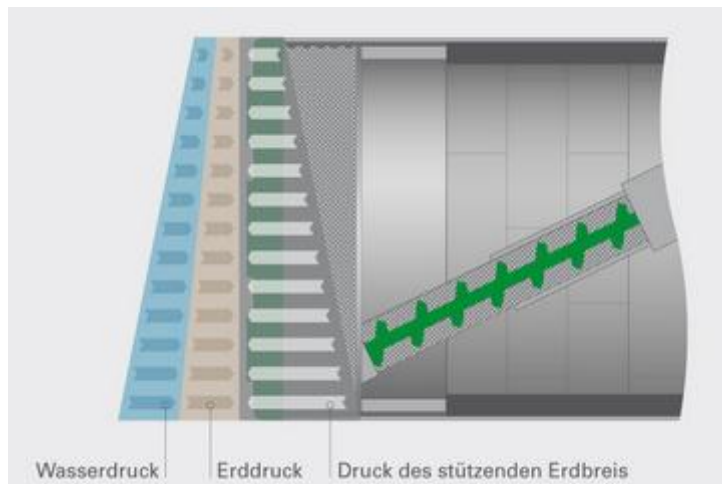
Systemskizze im Grundriss – Erddruckstützung [8], [13]
